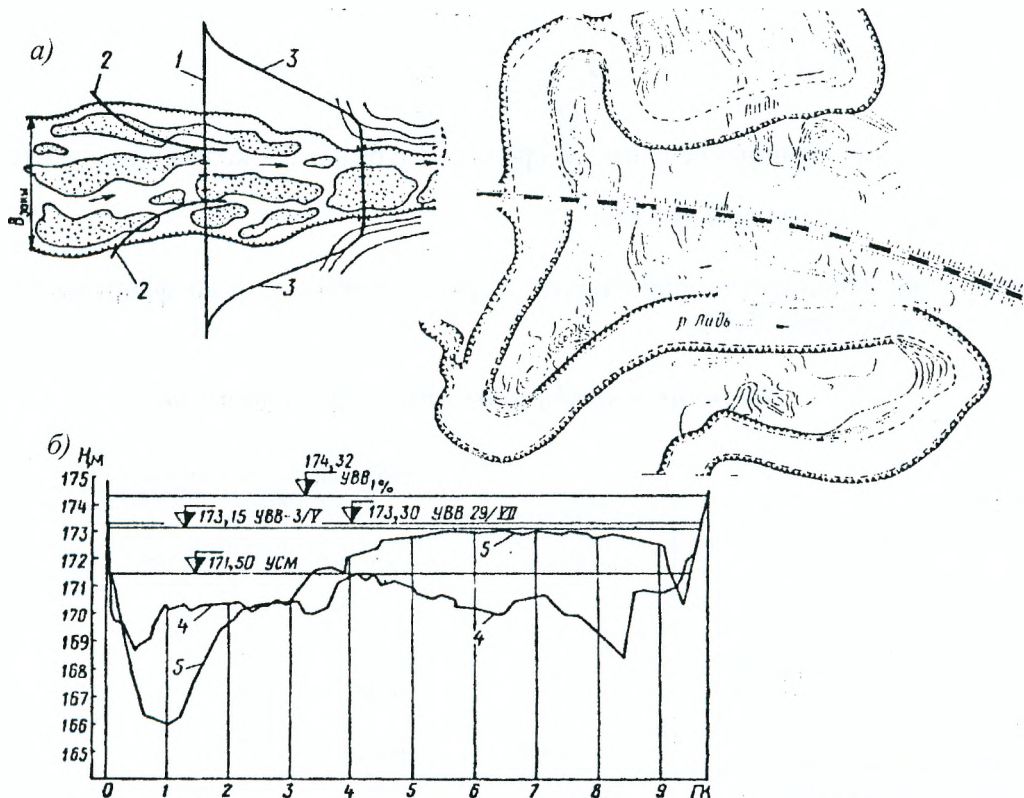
Переход через реку с блуждающим руслом: а – план; б – совмещенные профили живых сечений; 1 – трасса перехода, стесняющего зону блуждания; 2 – струна-направляющие дамбы; 3 – переход, не стесняющий зону блуждания; 4 – живое сечение на 3/V-97 г.; 5 – то же, на 29/VII-97 г.
